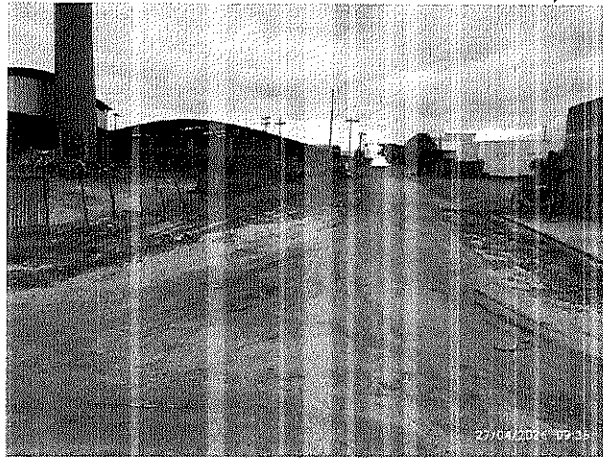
Rua Acre (entre a Avenida Rio de Janeiro e Rua Piauí).
